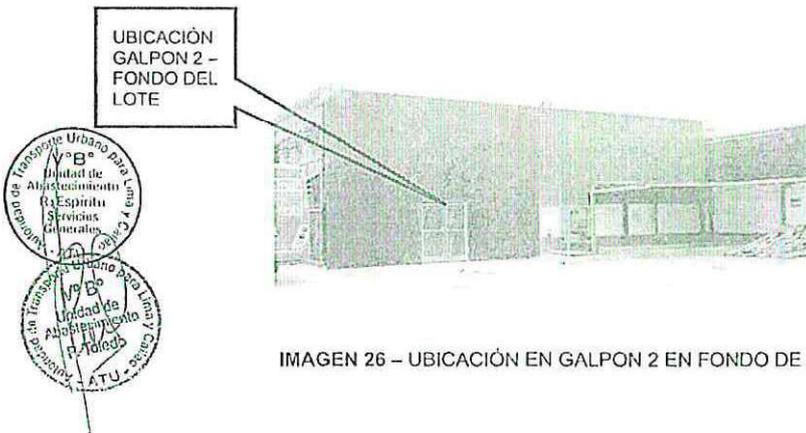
UBICACIÓN EN GALPON 2 EN FONDO DE LOTE
